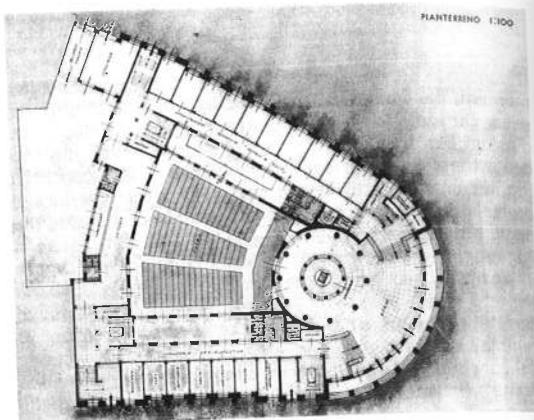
Pianta del piano terra del progetto di Battigelli e Spangaro.
